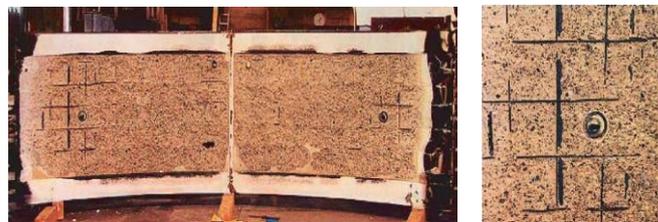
耐火試験後の超高強度コンクリートセグメントの爆裂状況と露出した鉄筋
